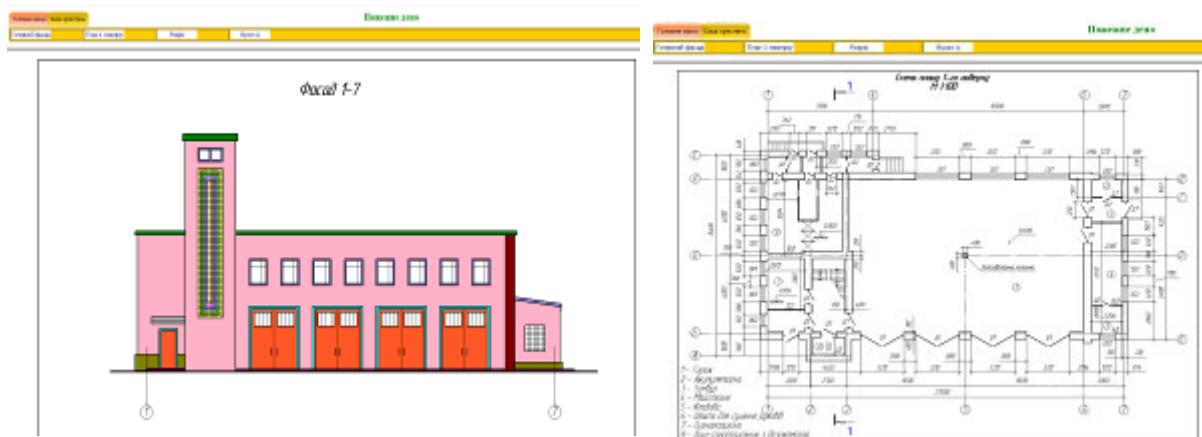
Електронний навчально-методичний комплекс, що містить креслення фасаду та план 1-го поверху будівлі пожежного депо
